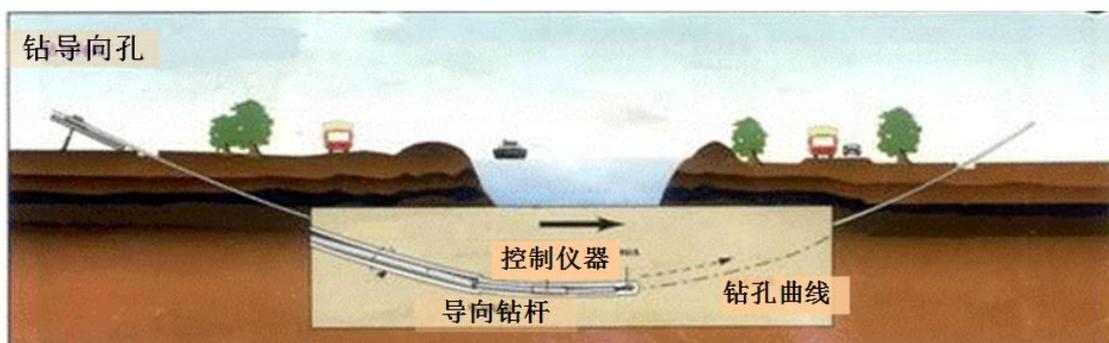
定向钻穿越施工钻导向孔过程断面示意图
